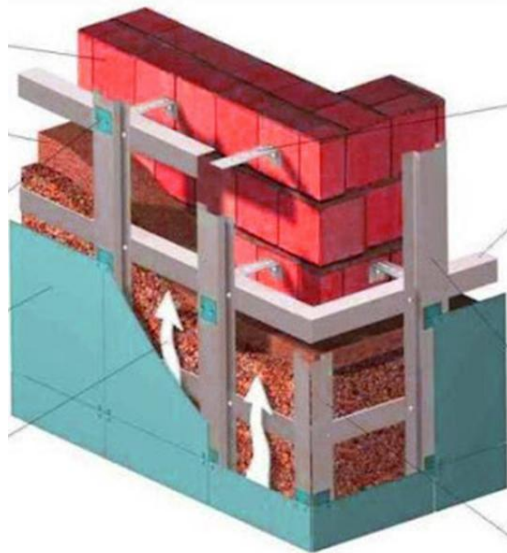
Утеплення фасаду за допомогою керамограніту
